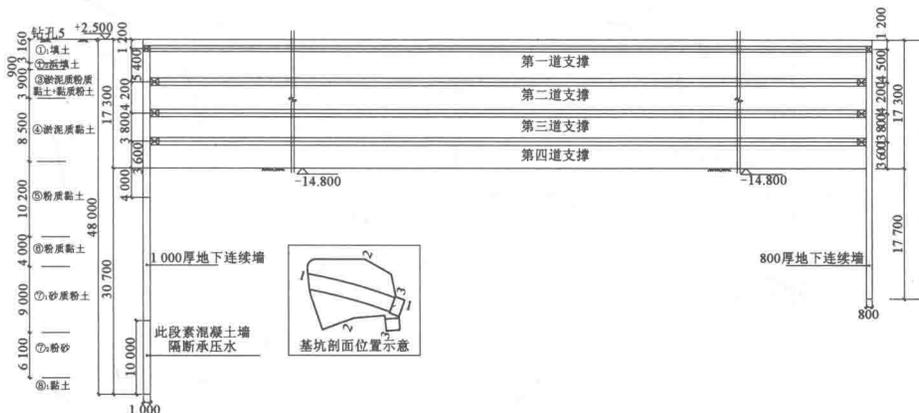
自博物馆基坑支护结构剖面图 (尺寸单位: mm; 高程单位: m)
